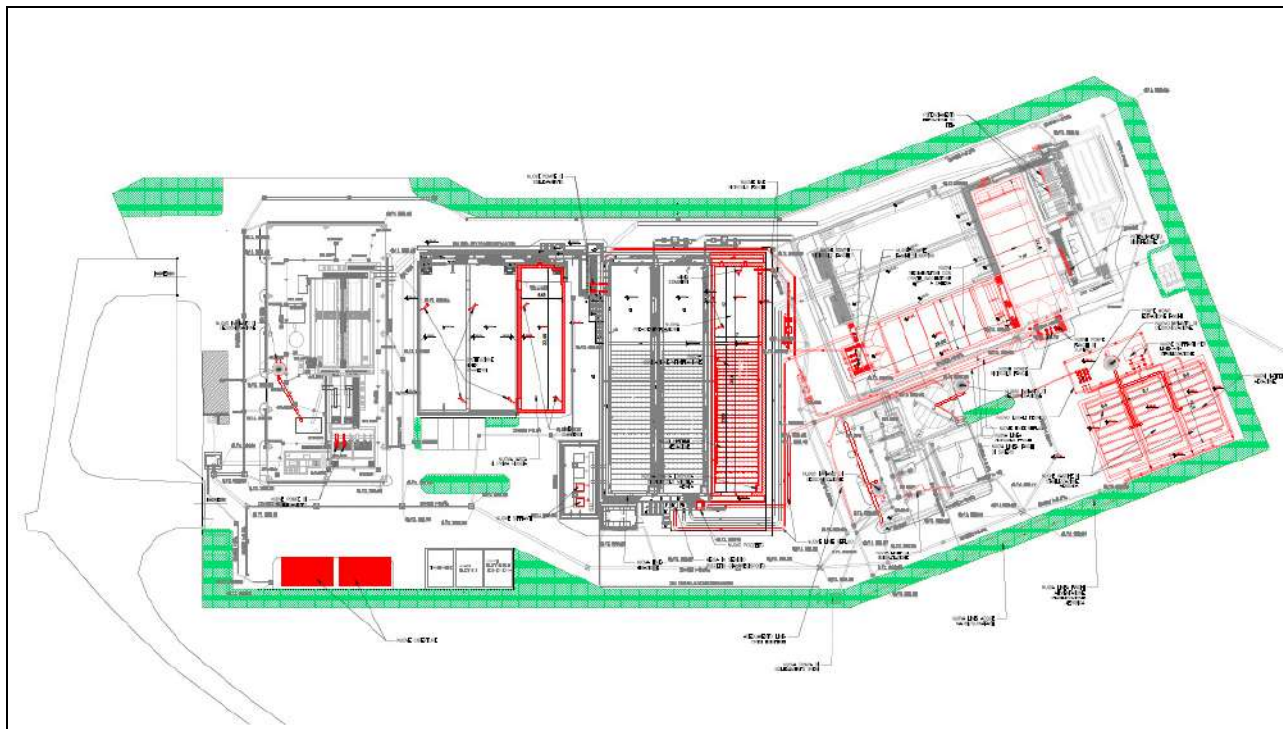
Stralcio planimetria degli interventi in progetto
